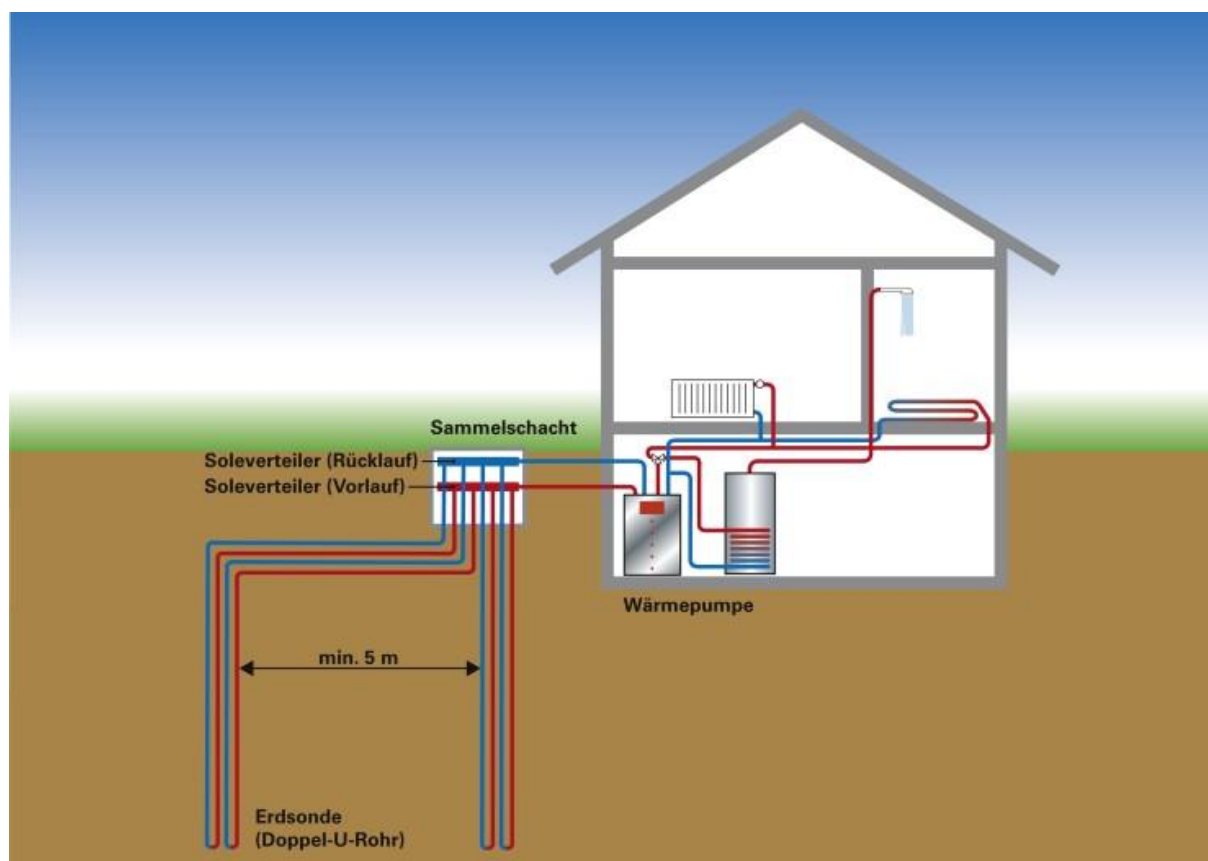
Schema einer Wärmepumpen-Heizung mit Erdsonden
